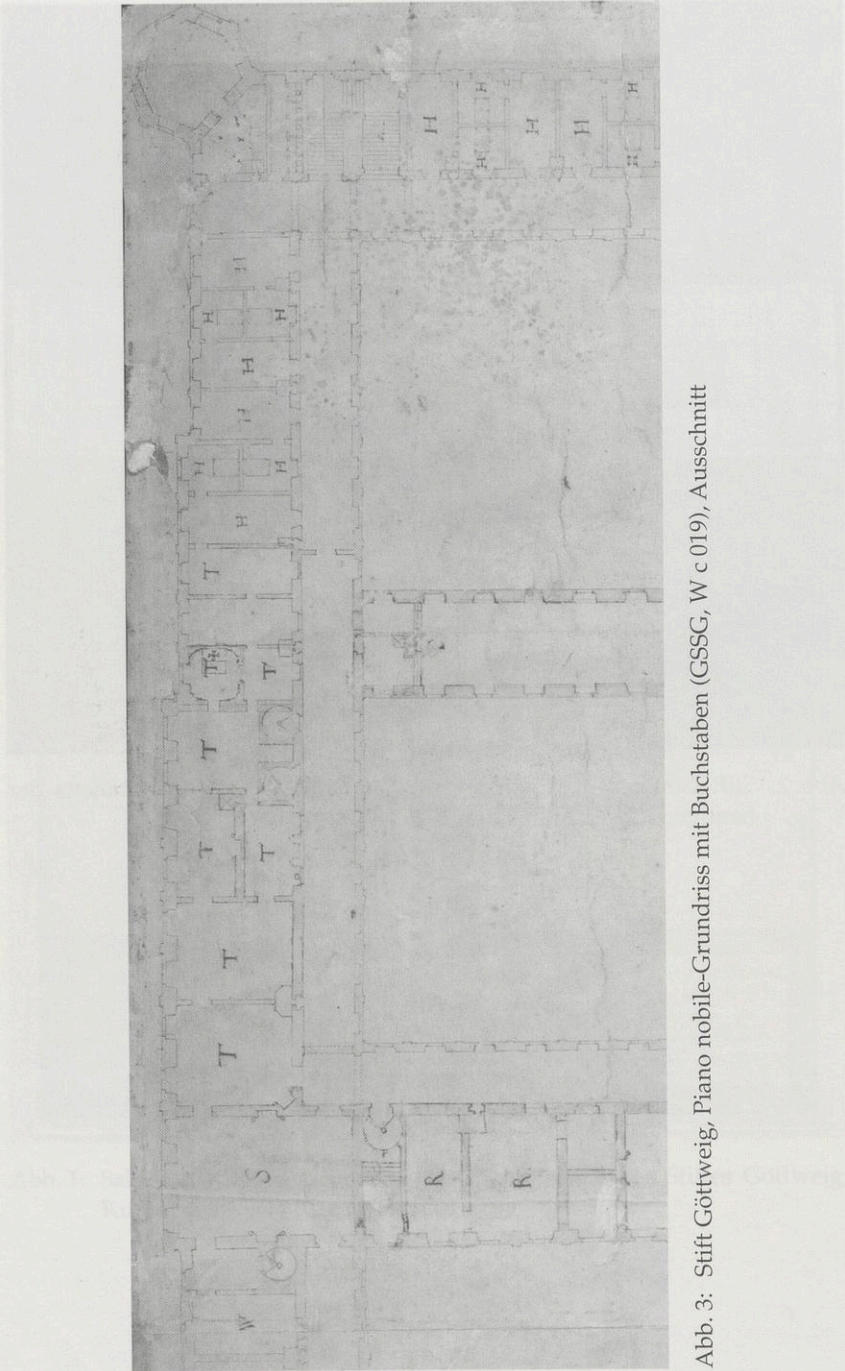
Stift Göttweig, Piano nobile-Grundriss mit Buchstaben (GSSG, W c 019), Ausschnitt
